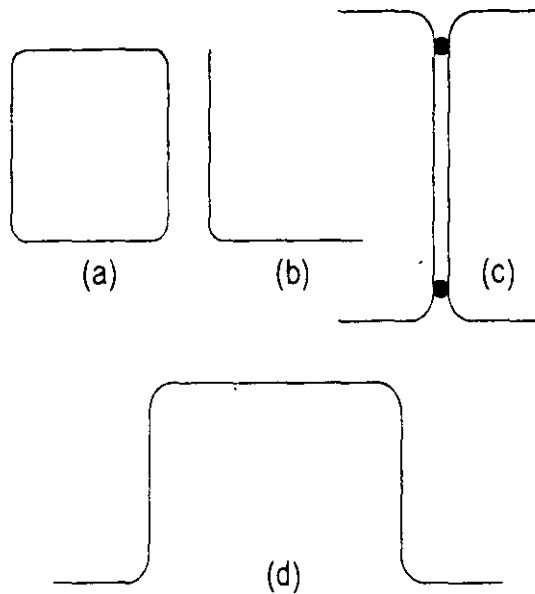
Ejemplos de secciones transversales de paredes delgadas
